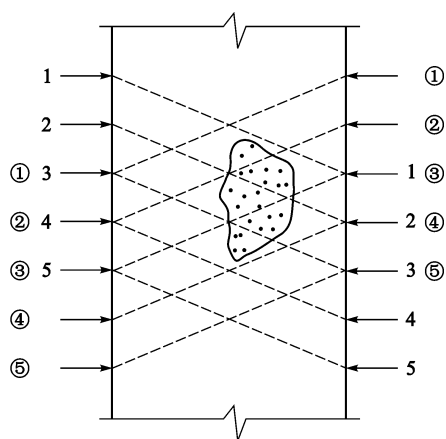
混凝土缺陷检测斜测法测点布置
